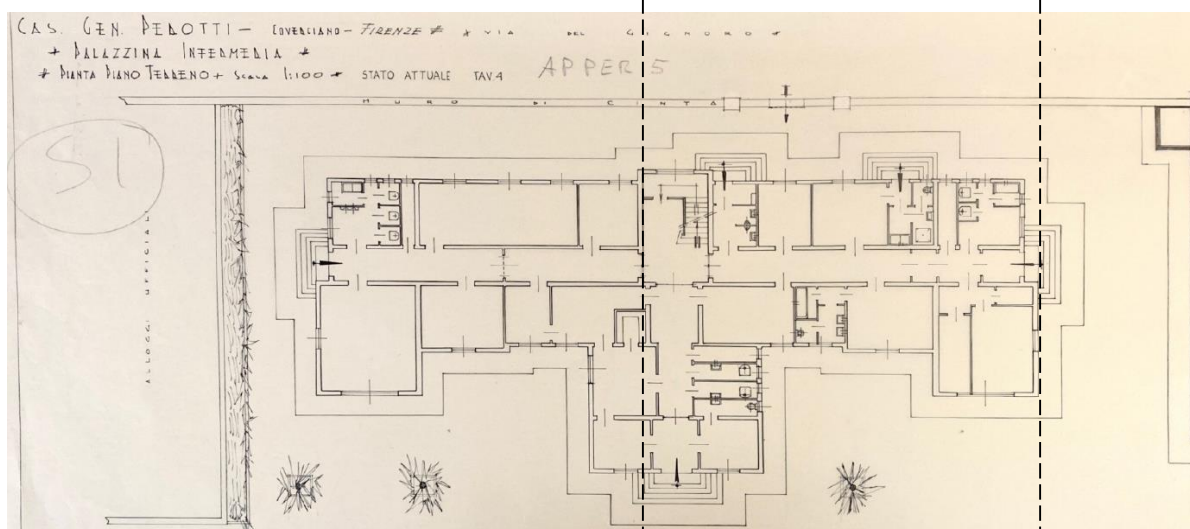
Pianta piano terra - distribuzione con vecchia funzione di infermeria.
